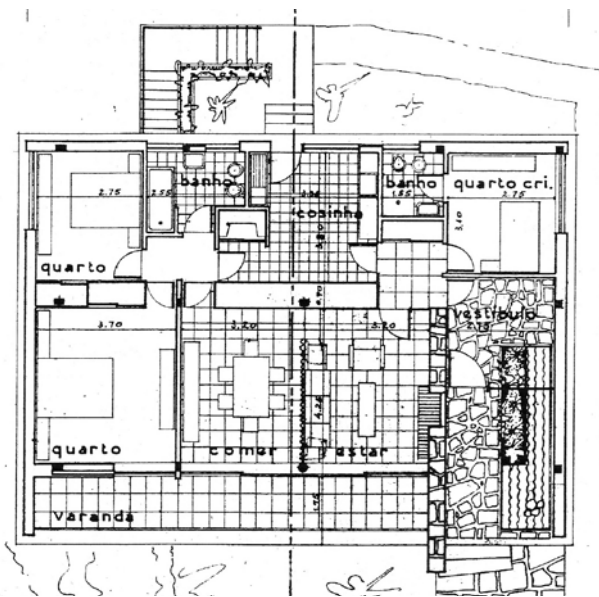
Casa Edilásio Silva, António Baroseiro, 1960. Planta piso 0.
